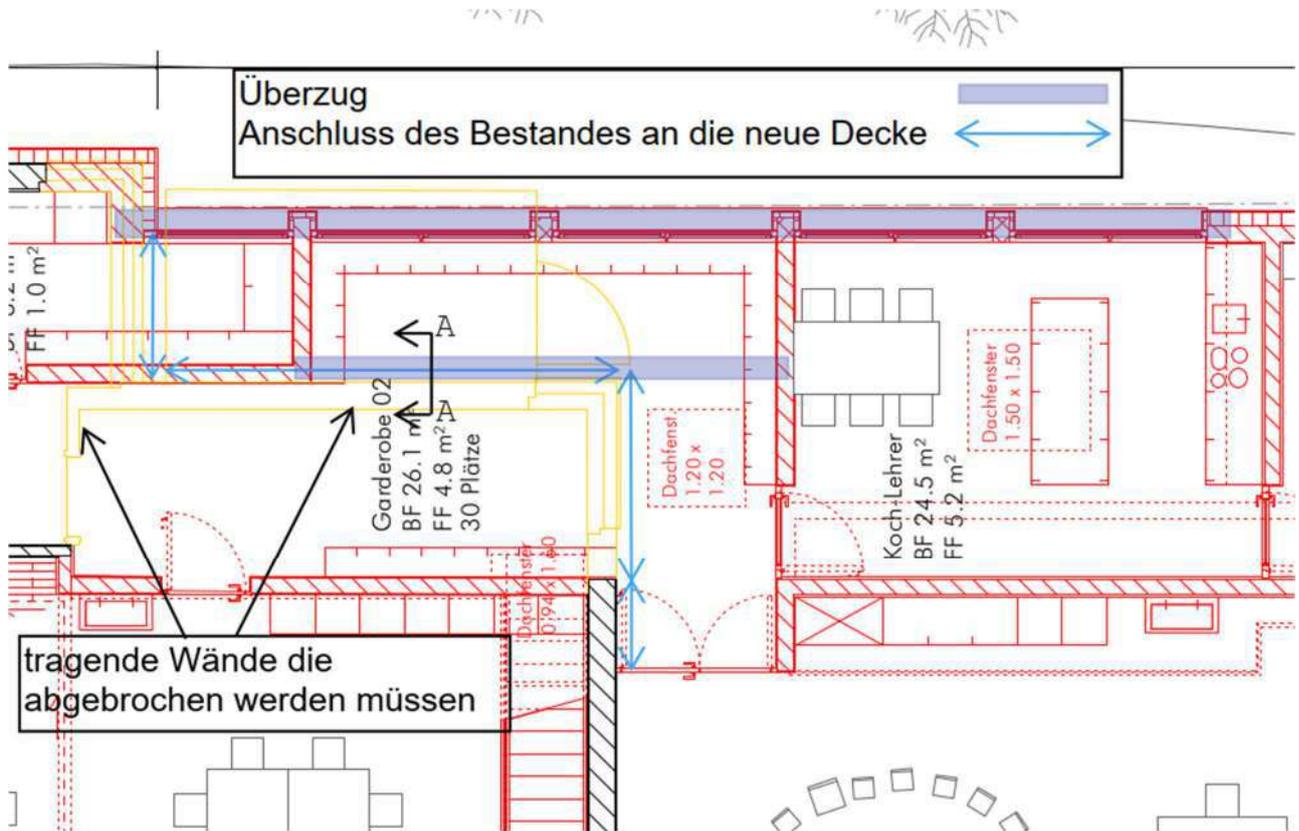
Anschluss der neuen Decke an der bestehenden (Grundriss)
